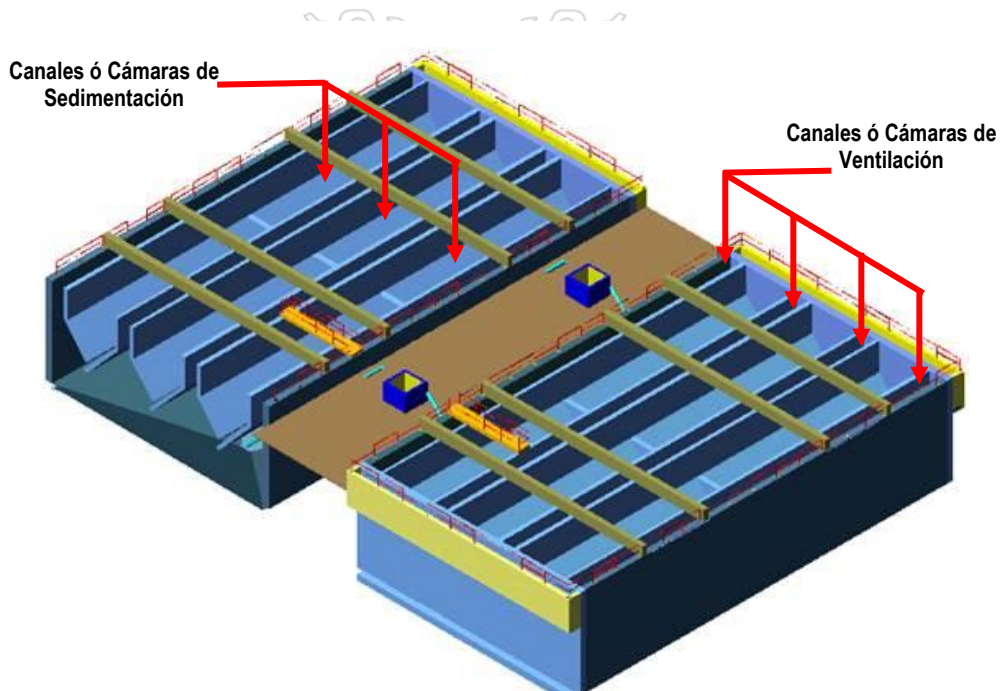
Vista isométrica del detalle constructivo y de componentes de los tanques Imhoff 3 y 4.
